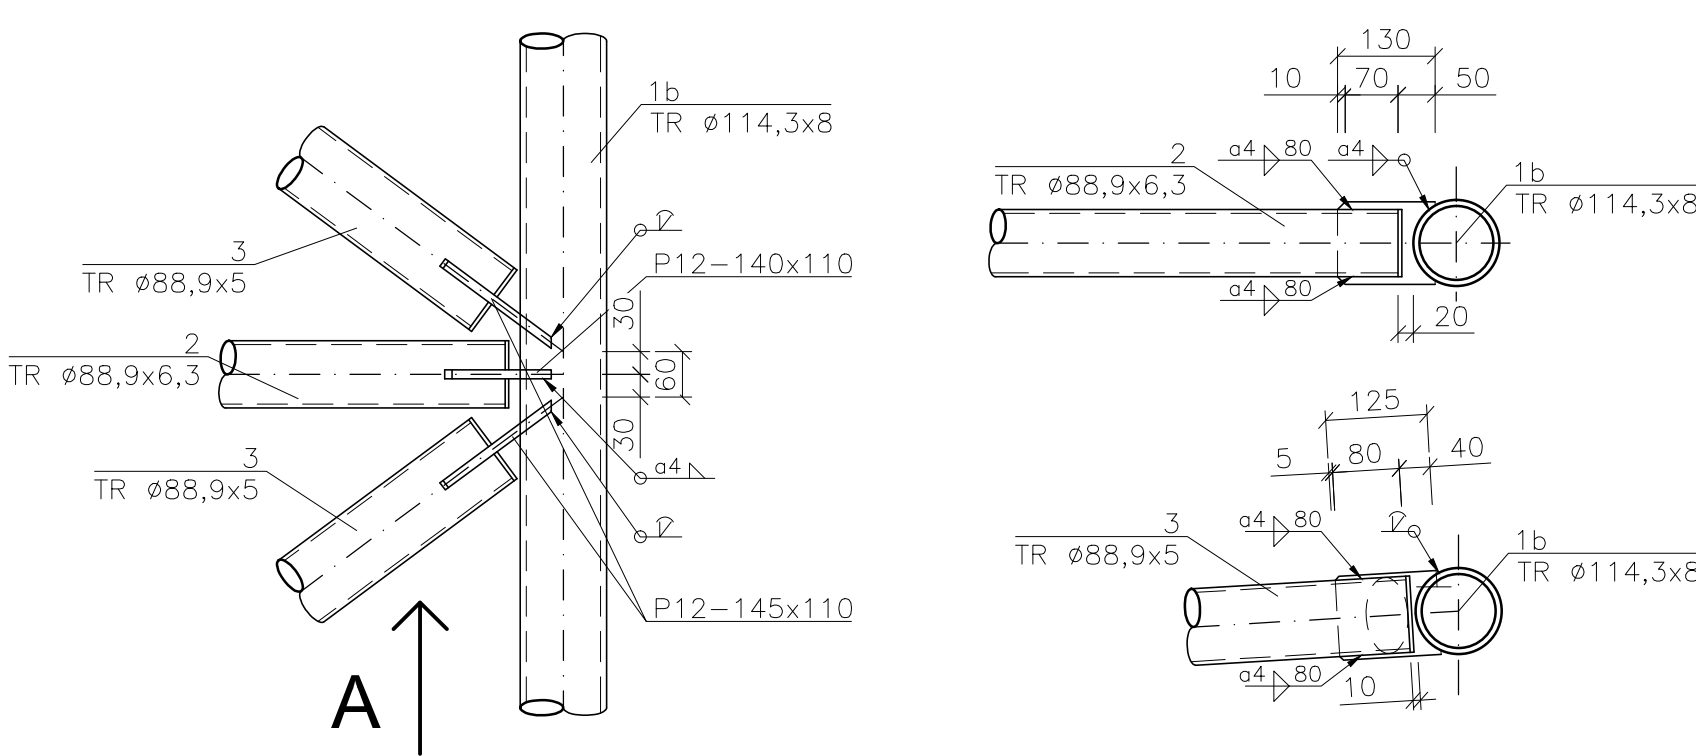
DETAIL KŘÍŽENÍ ZAVĚTROVÁNÍ
